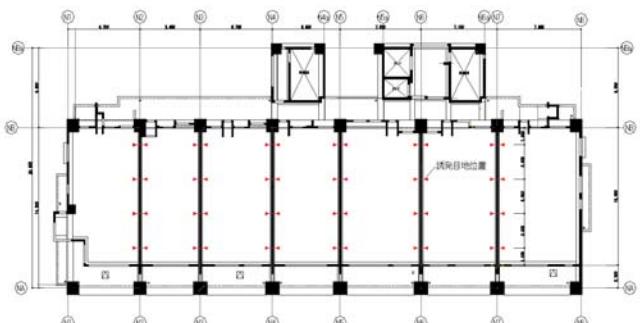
建物全体でのひび割れ誘発目地設置位置
